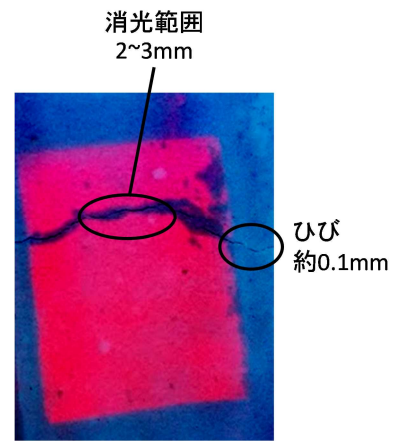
ひび割れ検出塗膜による微小ひびの拡大検出
